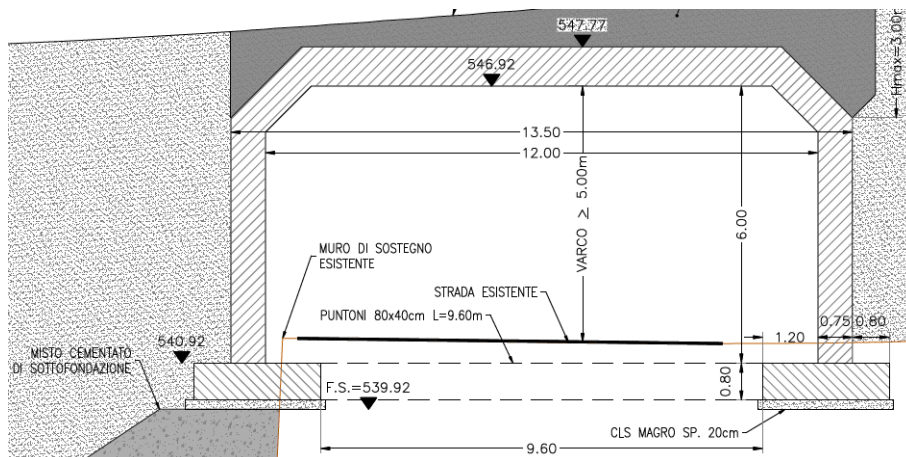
Sezione A-A, fondazioni dello scatolare
